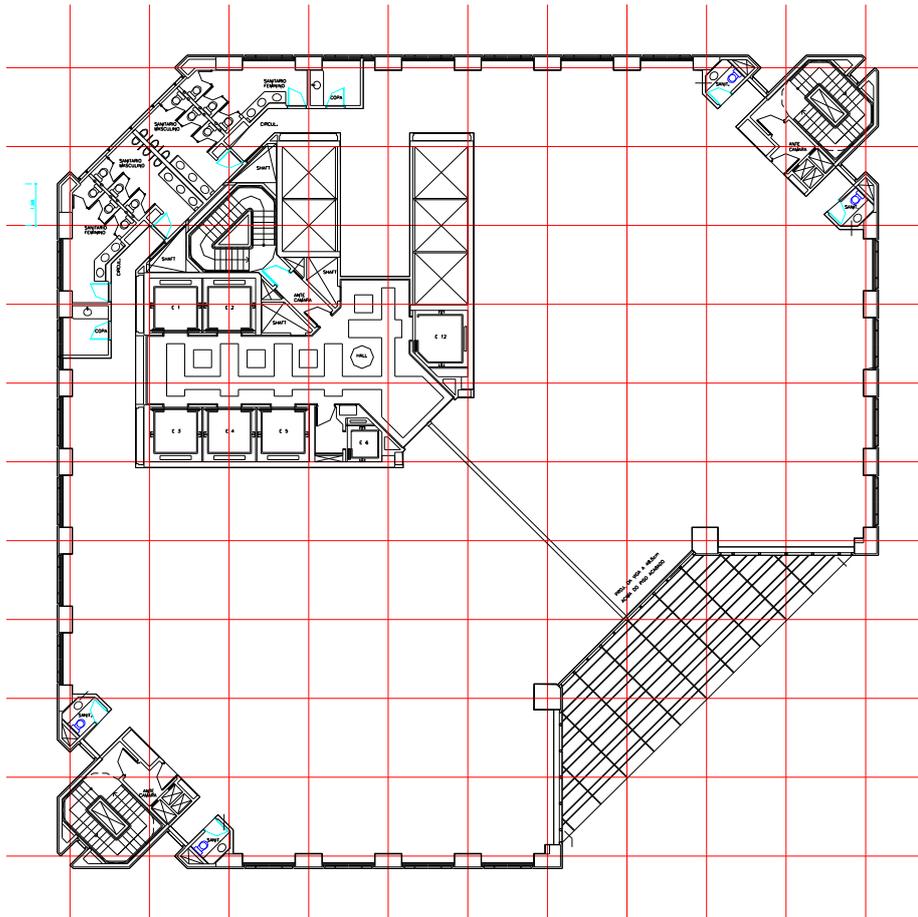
Planta pavimento-tipo 8º ao 12º - Torre Oeste – CENU
